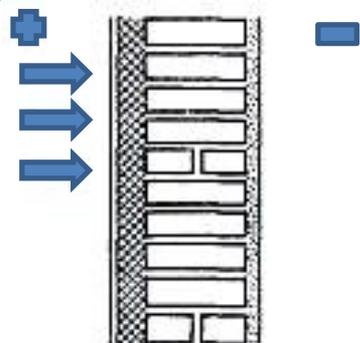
Кирпичная стена с внутренней теплоизоляцией.
